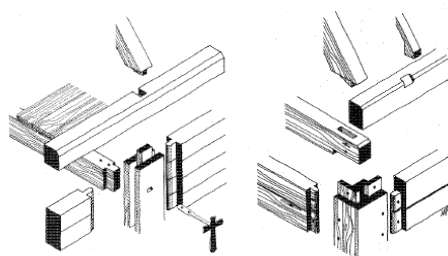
Pormenores do sistema "Poteaux en coulisse" de uma casa no Québec, Canadá (Clayton, 1990).
